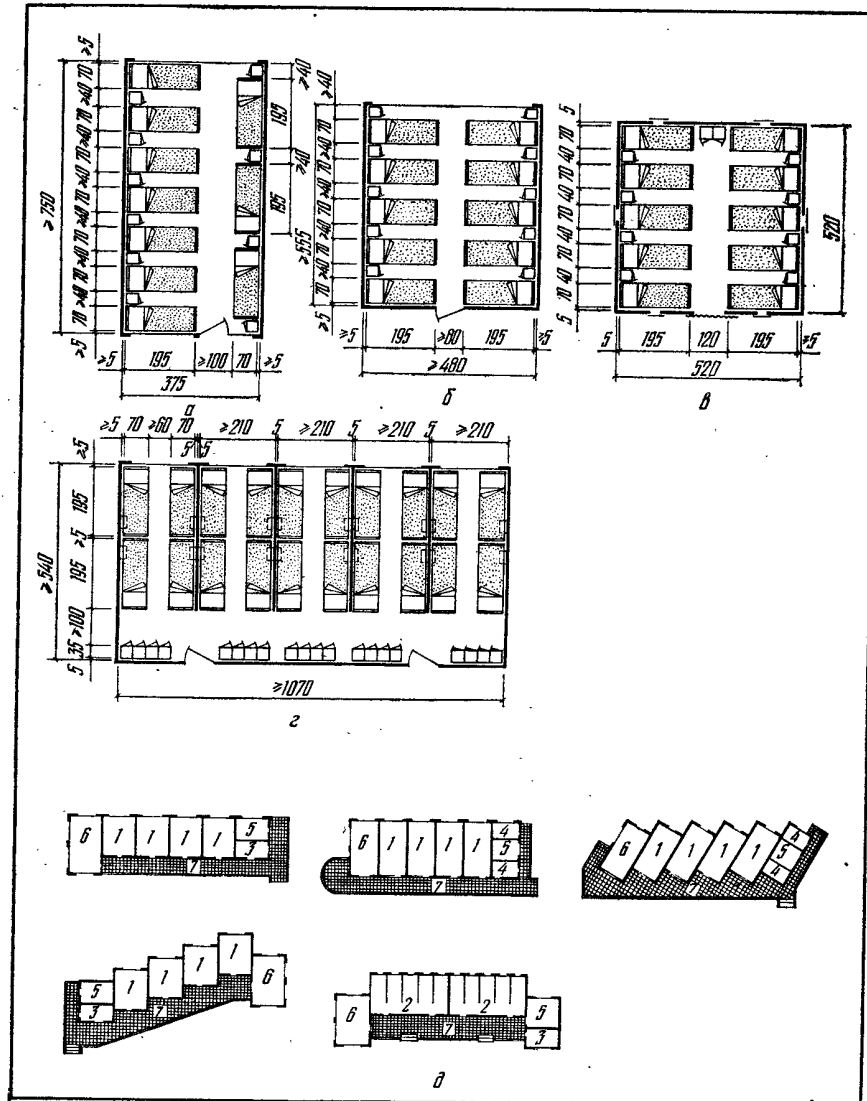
Примеры и габаритные схемы планировки спальных помещений:
